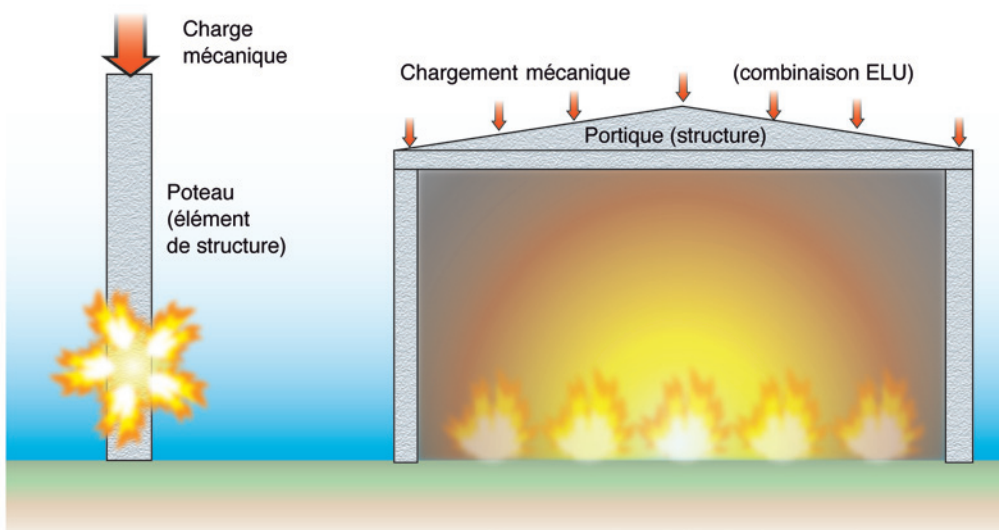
stabilité au feu d'un élément isolé et d'une structure
